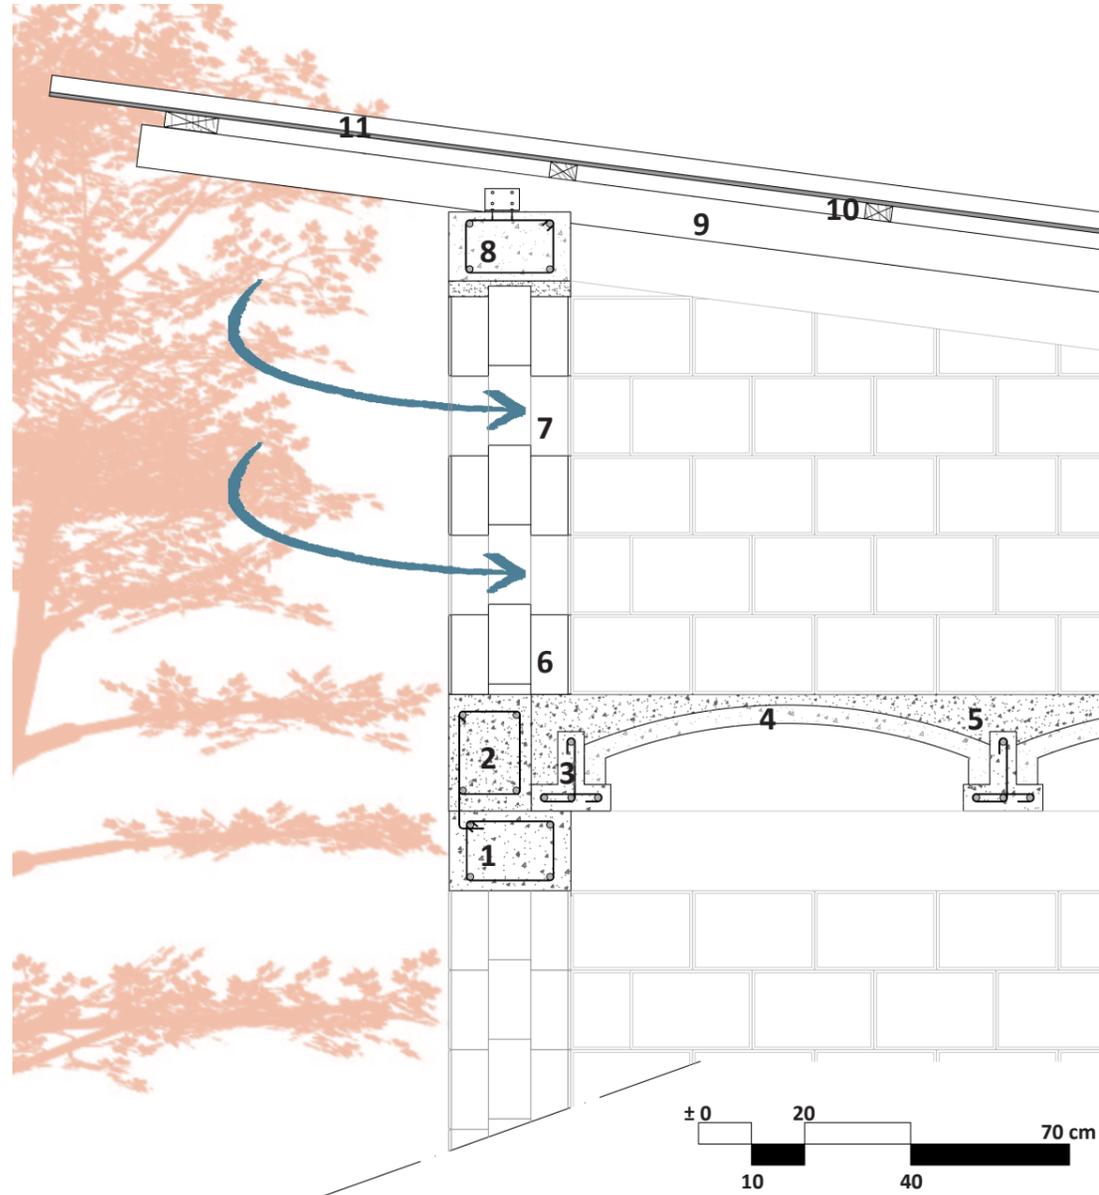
Dettaglio tetto e solaio Landie. (Fonte: Elaborazione propria).
